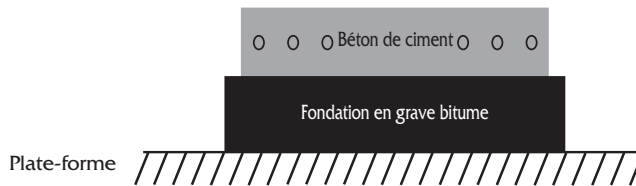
structure composite constituée d'un revêtement béton à joints goujonnés posé sur une fondation en grave-bitume.
